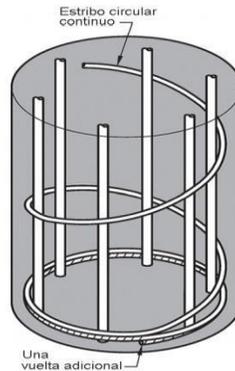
Estribos y ganchos suplementarios en columnas
